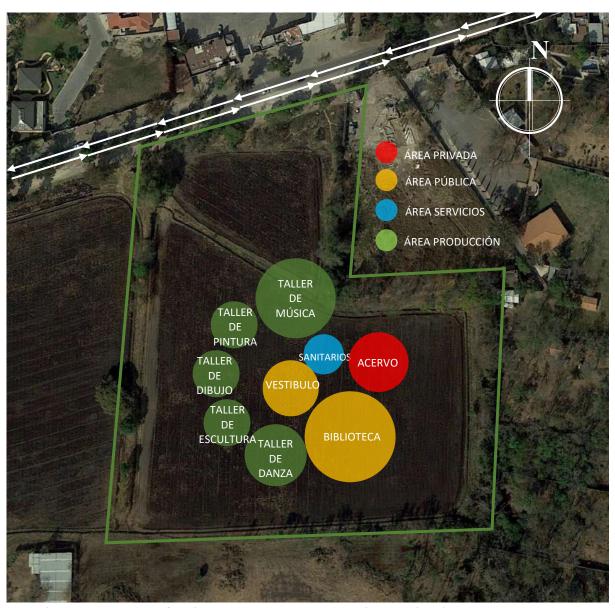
Propuesta de zonificación PLANTA ALTA. Fuente: Elaboración propia. (2018).
